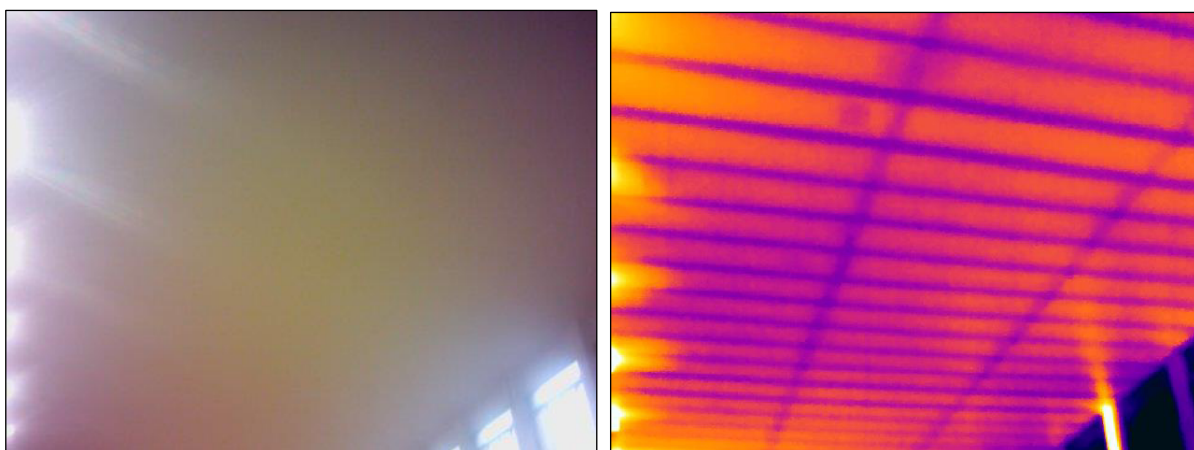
Individuazione della tramatura caratteristica dell'intradosso della Palestra al piano terra.
